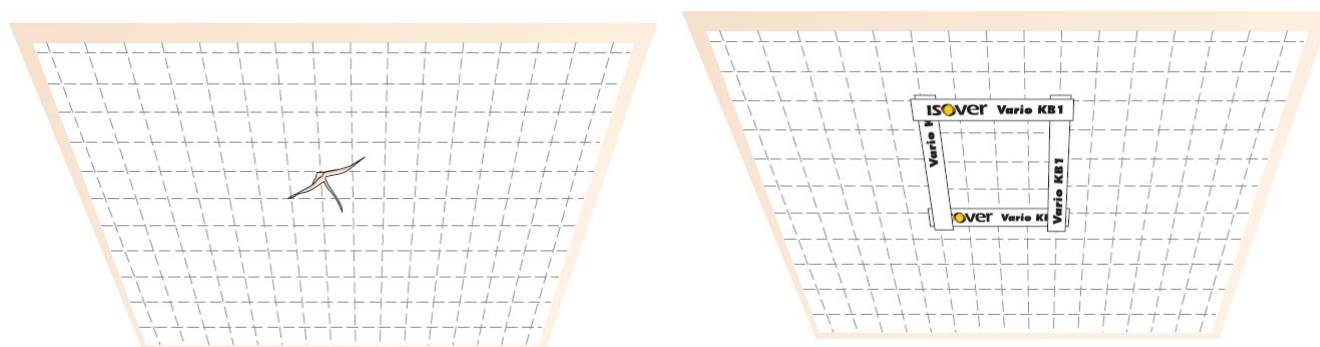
Réparation d'une déchirure ou entaille de grande dimension
